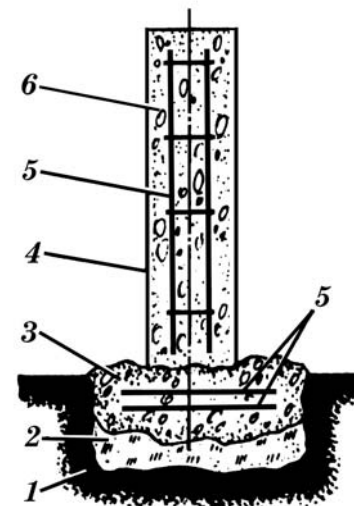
Конструктивная схема столбчатого набивного фундамента мелкозаглубленного заложения (для сезонных садово-огородных домов и столбов ограждений): 1 – грунт; 2 – песок; 3 – бетонная подушка; 4 – труба-опалубка; 5 – арматура; 6 – бетонная смесь.
